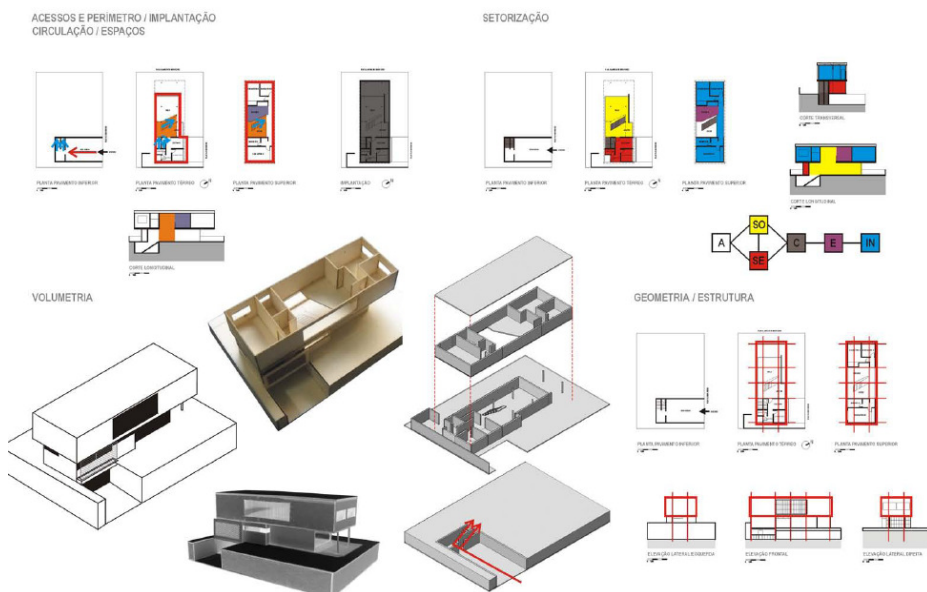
Diagrama 1 - Análise acessos e perímetros, implantação, circulação e espaços, setorização, volumetria, geometria e estrutura das plantas térreas, pavimento inferior, pavimento superior, implantação, cortes e elevações da casa residência Roberto Salmeron, 1949. Fonte: FLORIO, 2012, p. 202
